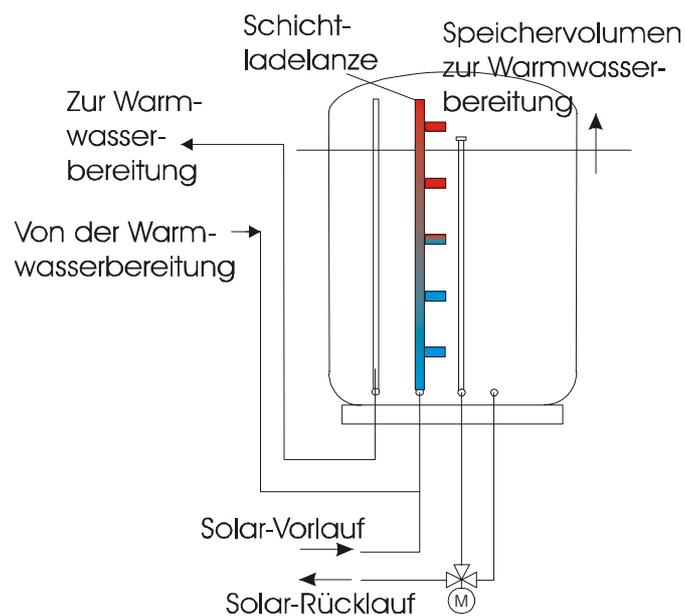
„Speicherteilung“ bei Fassadenkollektoranlagen zur Gewährleistung einer effizienten Warmwasserbereitung außerhalb der Heizsaison.
